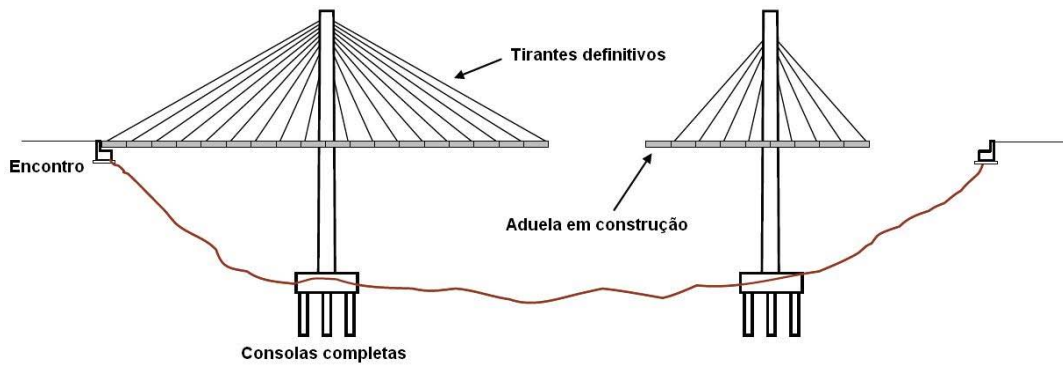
Esquemática do processo de construção de uma ponte atirantada.
